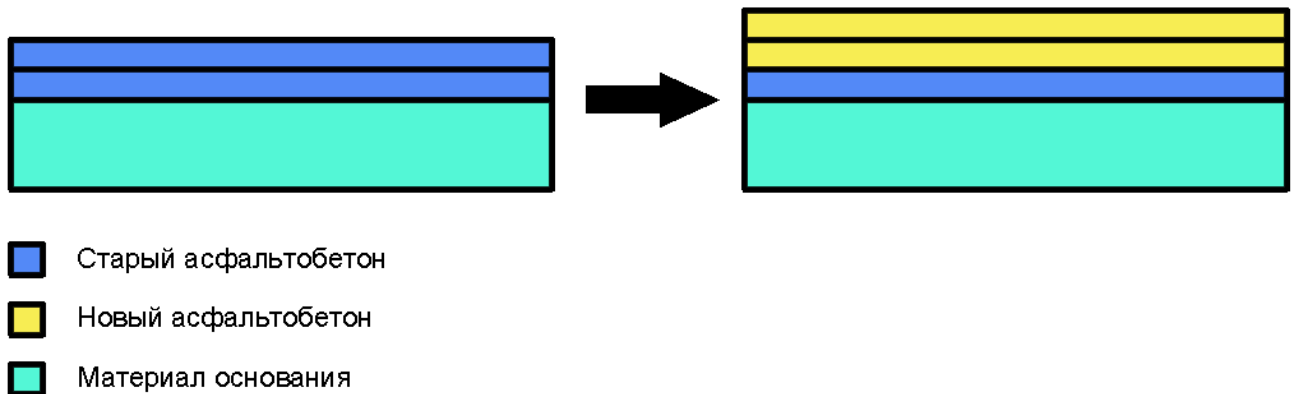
Схема проведения капитального ремонта дорожного асфальтобетонного покрытия с его частичным, либо полным удалением
